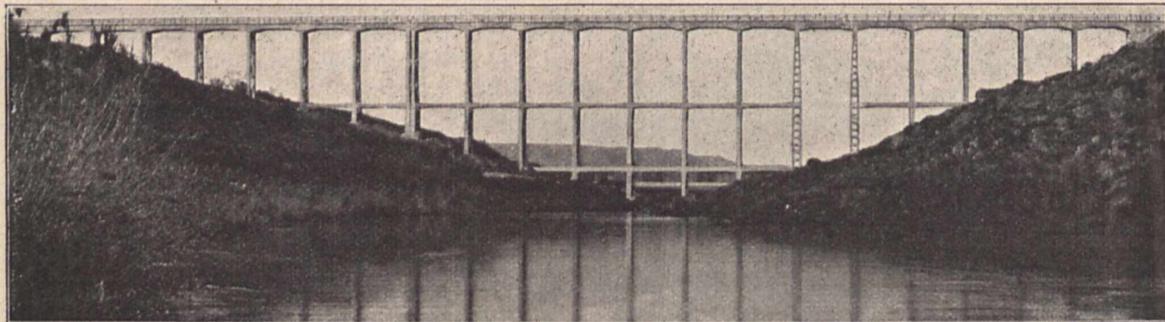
Brücke aus Eisenbeton über den Stausee.
